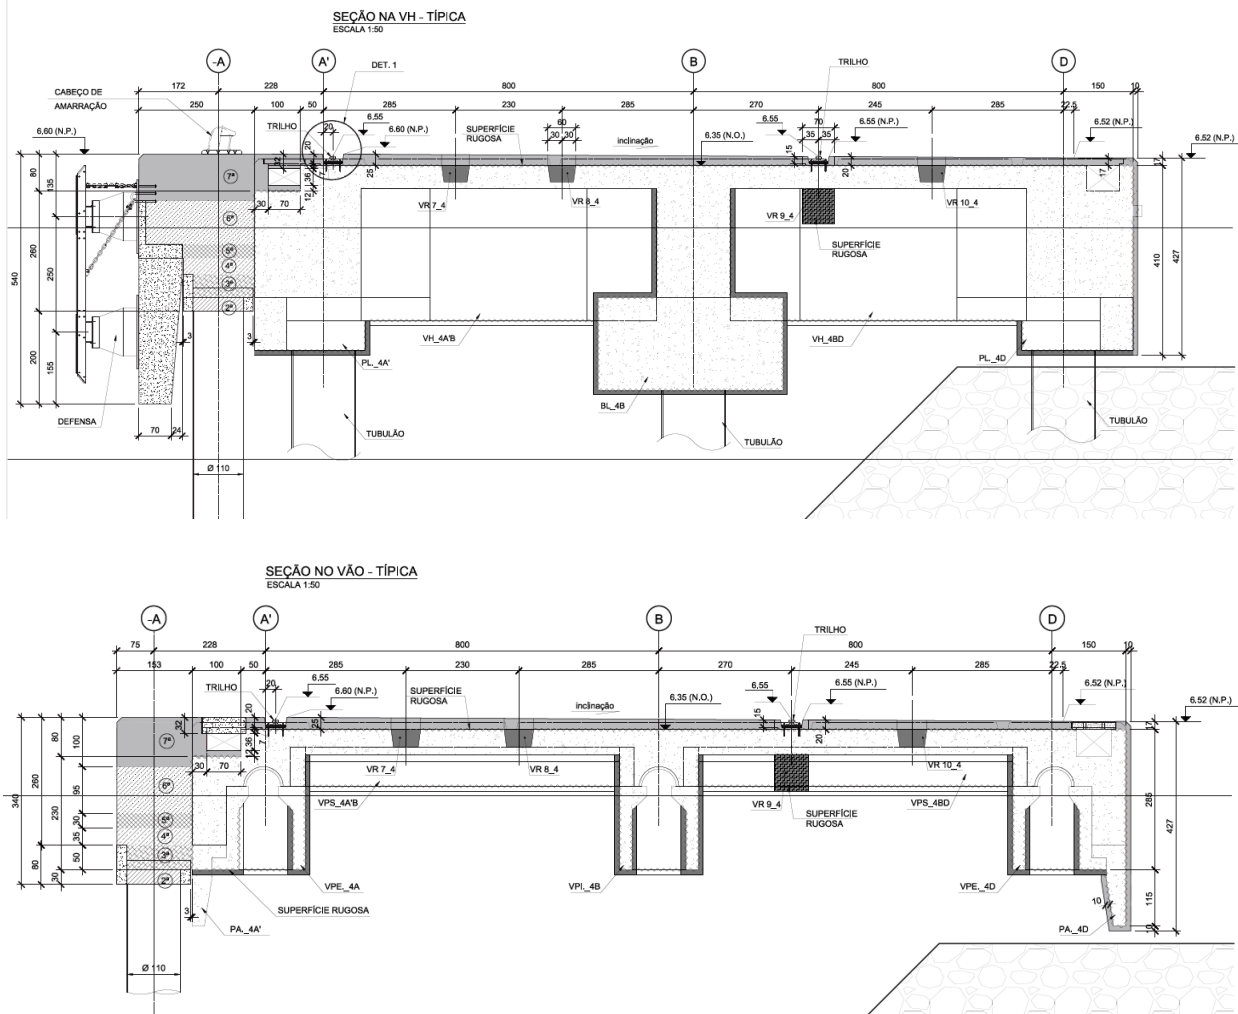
Corte transversal - formas da superestrutura no apoio e no vão
